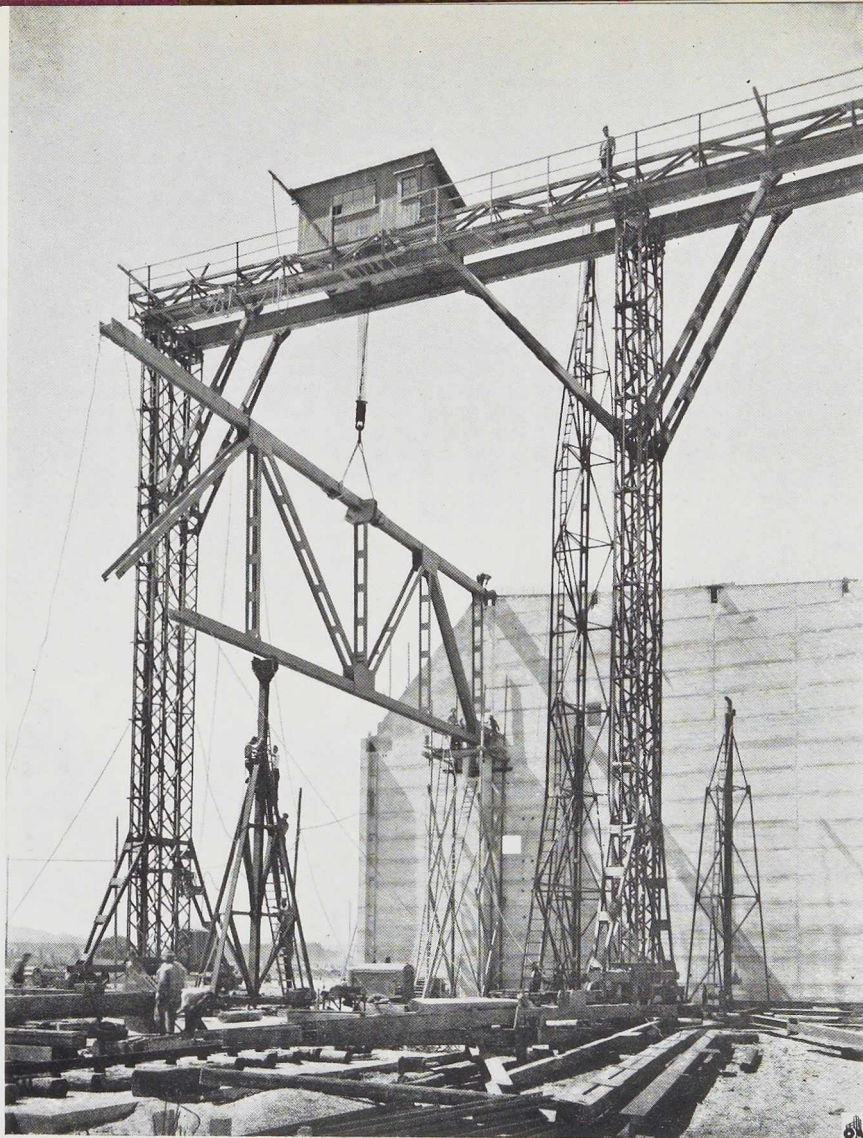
Mise en place de la dernière partie de la maîtresse-poutre du hall de montage à Kloten-Zurich.
